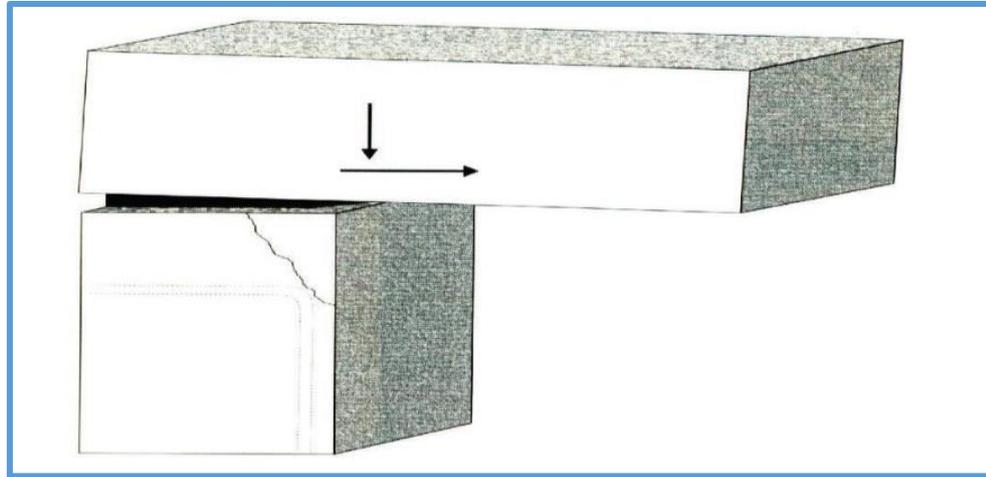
Patrón de fractura de borde, por rigidez del apoyo.
